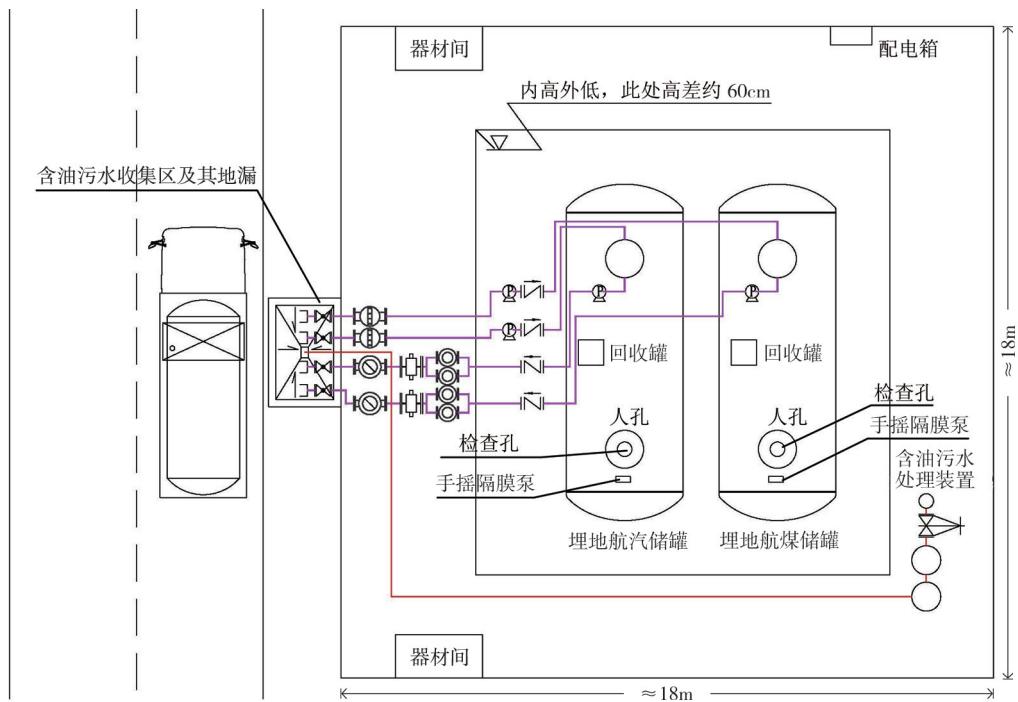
某通用机场加油站设施设备平面图 2
